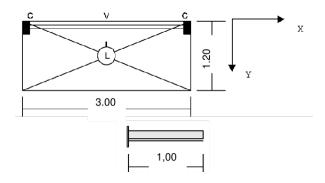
Planta de la columna correspondiente al ejercicio 2)
